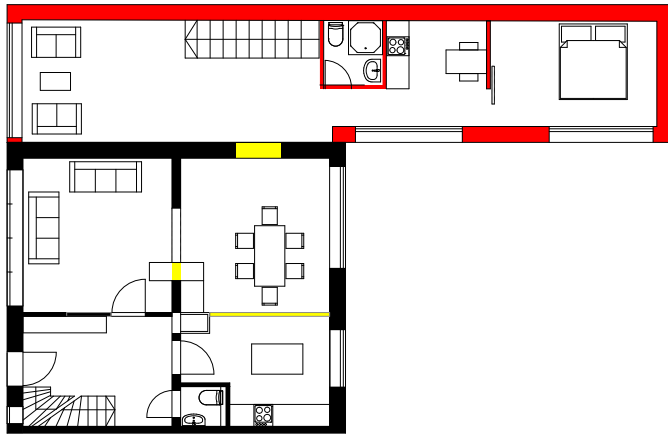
Änderungen im Grundriss des Bestands
